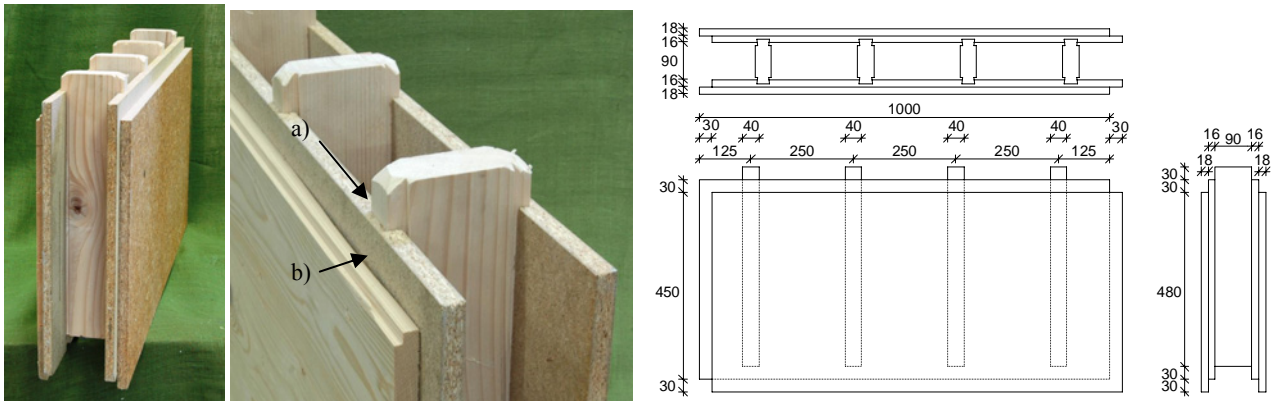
(links) Vorgefertigter Wandbaustein, (mitte) a) Detail überstehende Stege und b) Versatz der Beplankungslagen (rechts) Maße eines Grundelementes der Wanddicke 160 mm.
